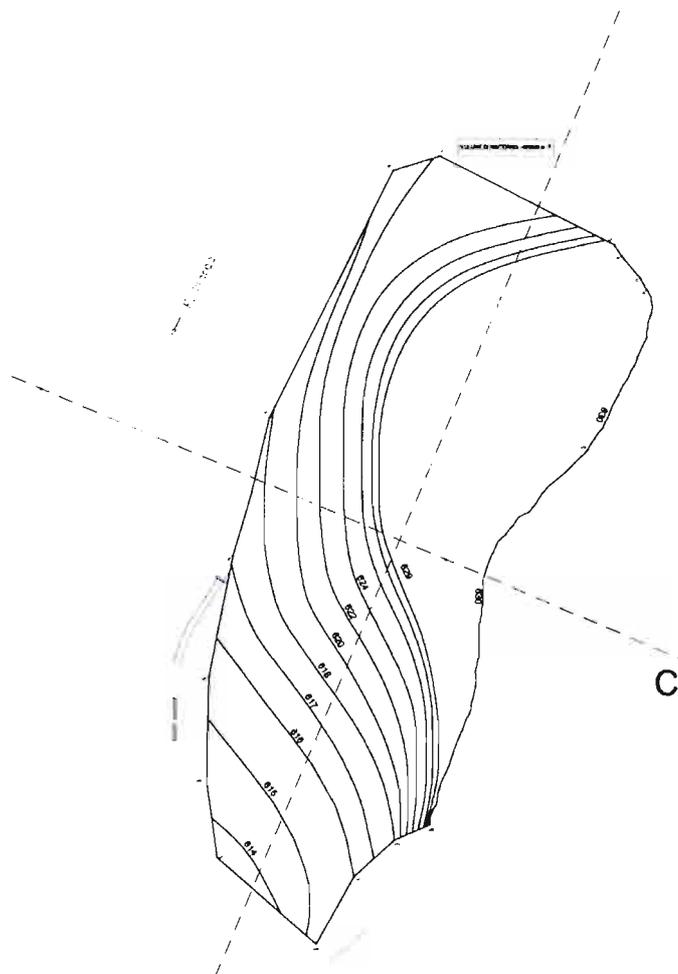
Planimetria di ripristino del sito Plaikner.
